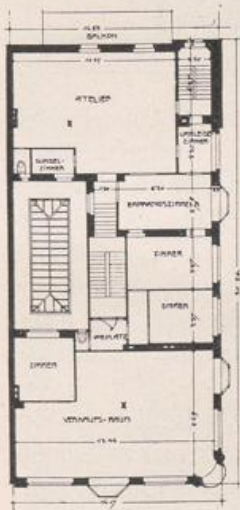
Schadowstr. 52. Obergeschoss. 1:500.
